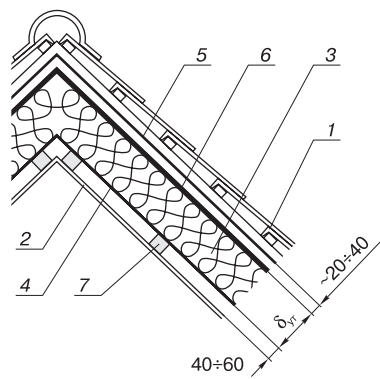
Утепление скатной крыши изделиями «URSA»: 1 – кровля; 2 – внутренняя облицовка; 3 – теплоизоляционные изделия «URSA»; 4 – пароизоляция; 5 – гидроизоляция; 6 – ветрозащита; 7 – обрешетка
